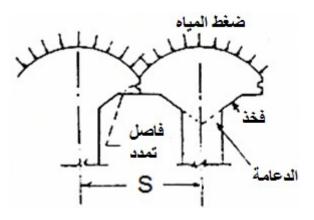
سد بني مطير (تونس)، سد دعائمي
